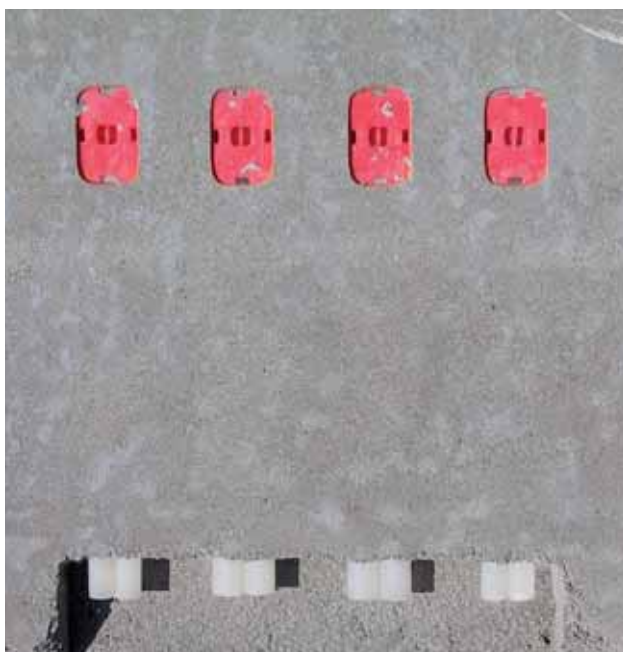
Ilægning af el i opsidens af et letklinkerbetonelement.
